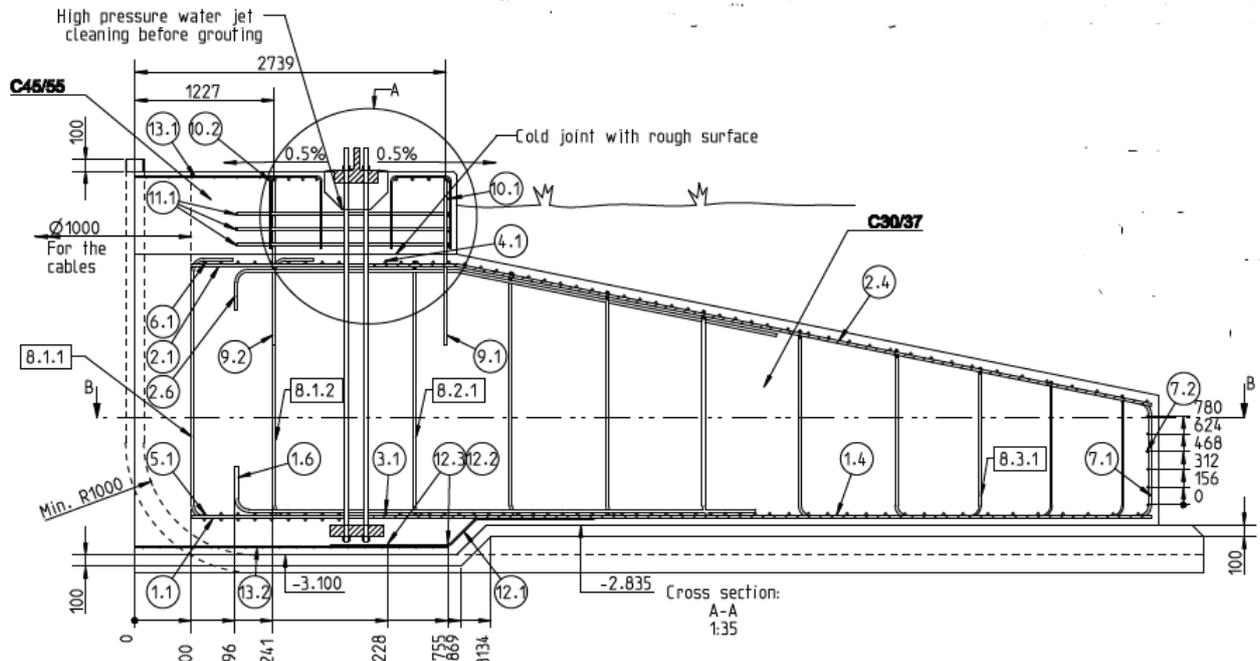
Sezione fondazione tipica VESTAS con indicazione ferri di armatura
